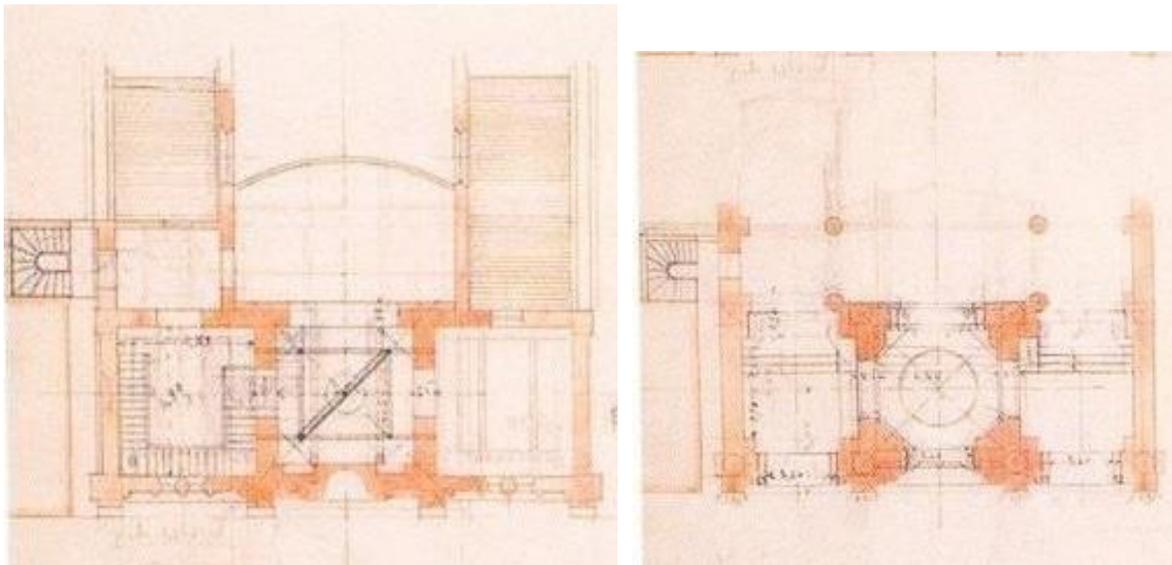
Esquemas en planta de alternativas para la base de la torre en San Rafael Arcángel. Fuente: Archivo Joannon.
